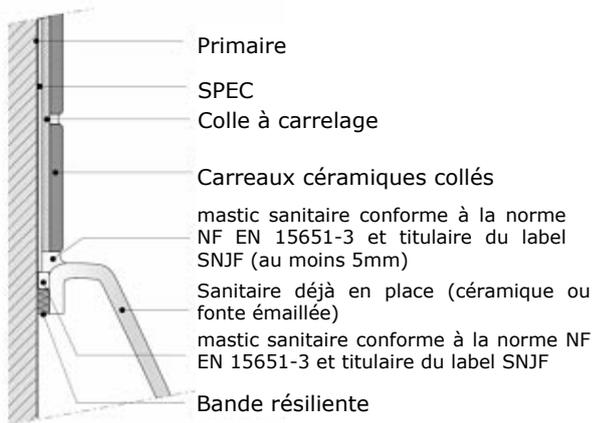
Raccordement du sanitaire à la paroi ; cas d'un sanitaire en céramique ou en fonte émaillée.
